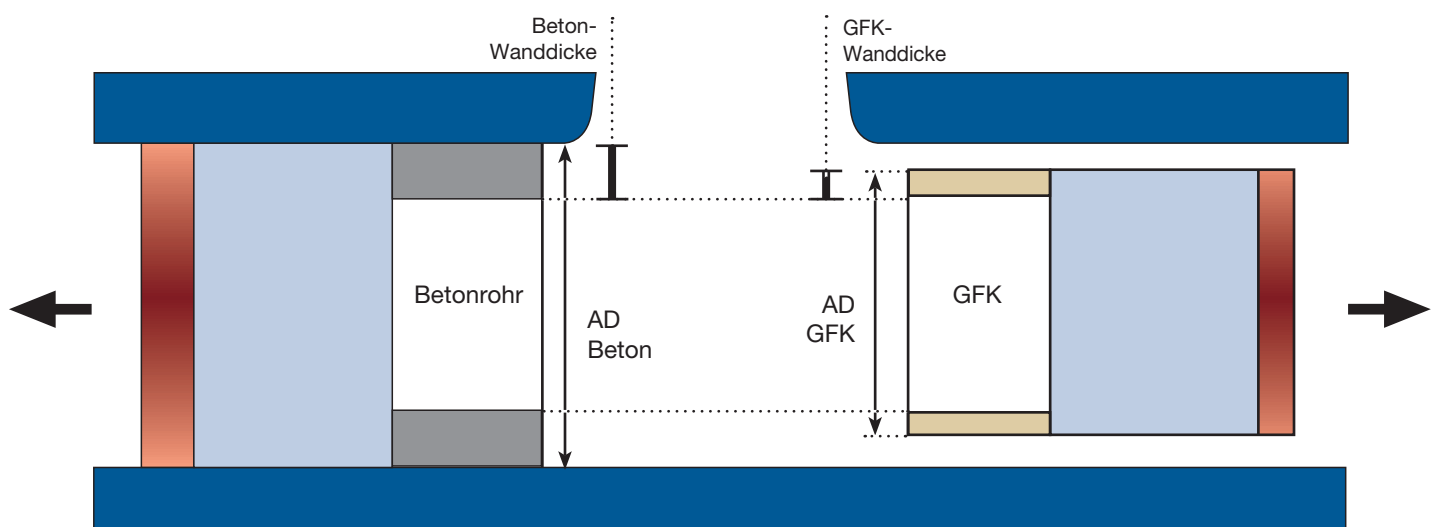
Vergleich Beton-GFK-Vortrieb
